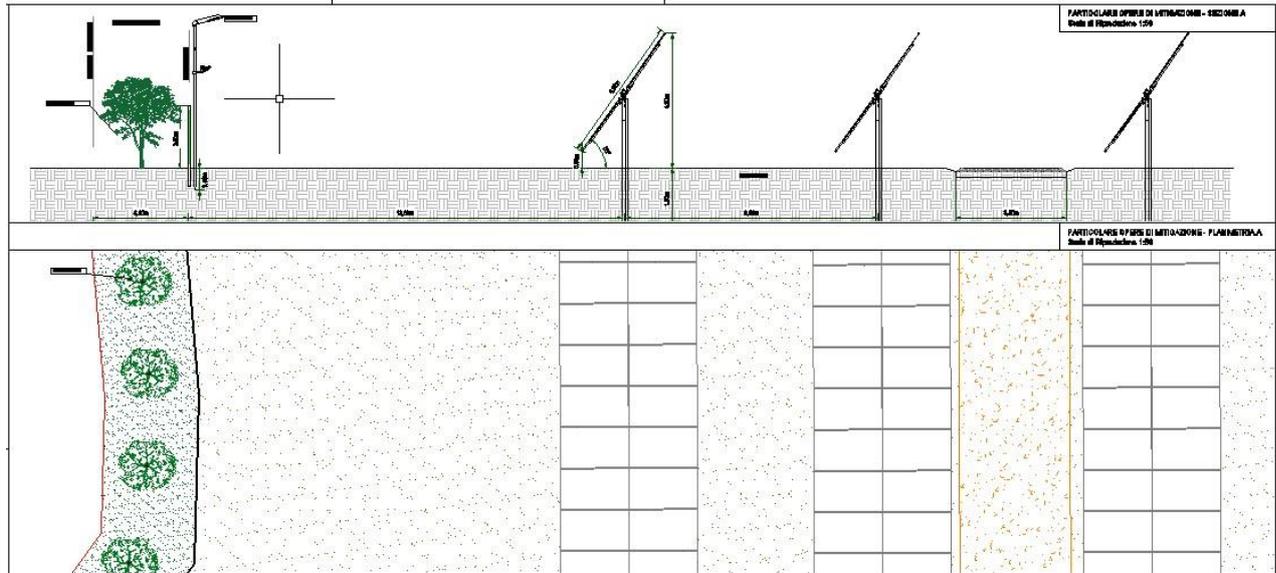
Opere di Mitigazione (Vista Pianta e Sezione)
